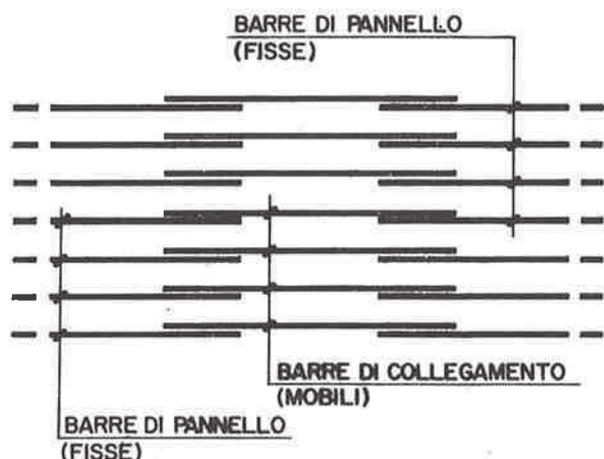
Collegamento tra gabbie contigue per sola sovrapposizione
